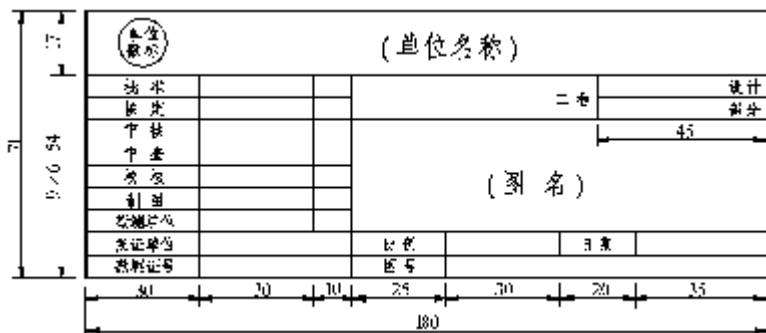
勘测通用标题栏 (A0~A1) (单位: mm)
